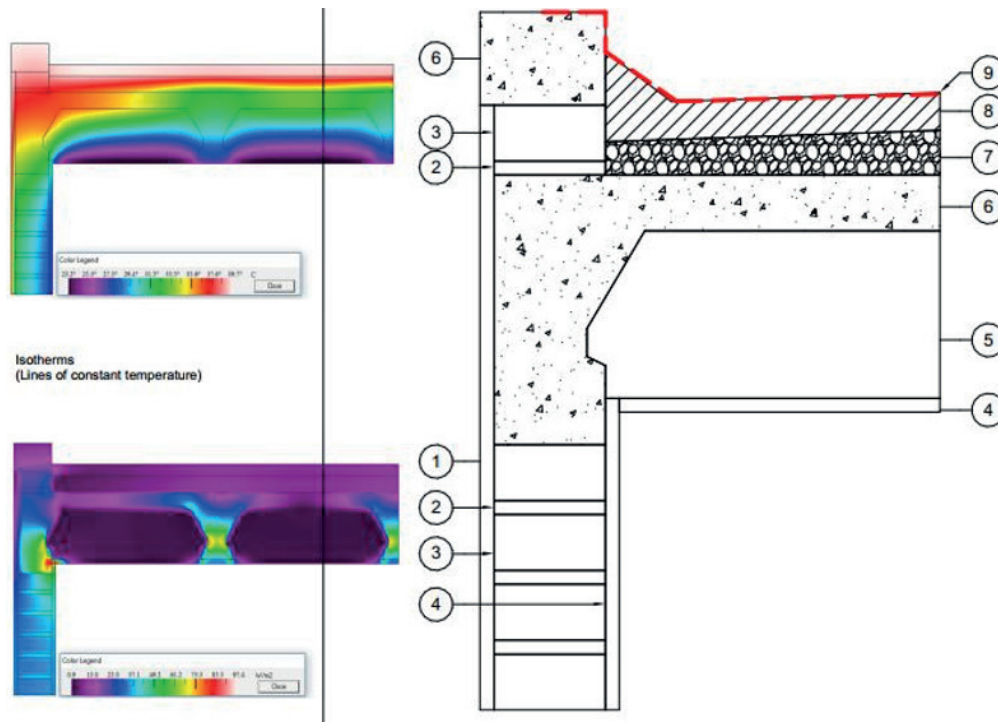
Herramienta de modelado térmico (THERM) aplicada a una losa de vigueta y bovedilla de poliestireno. Elaboración propia.
